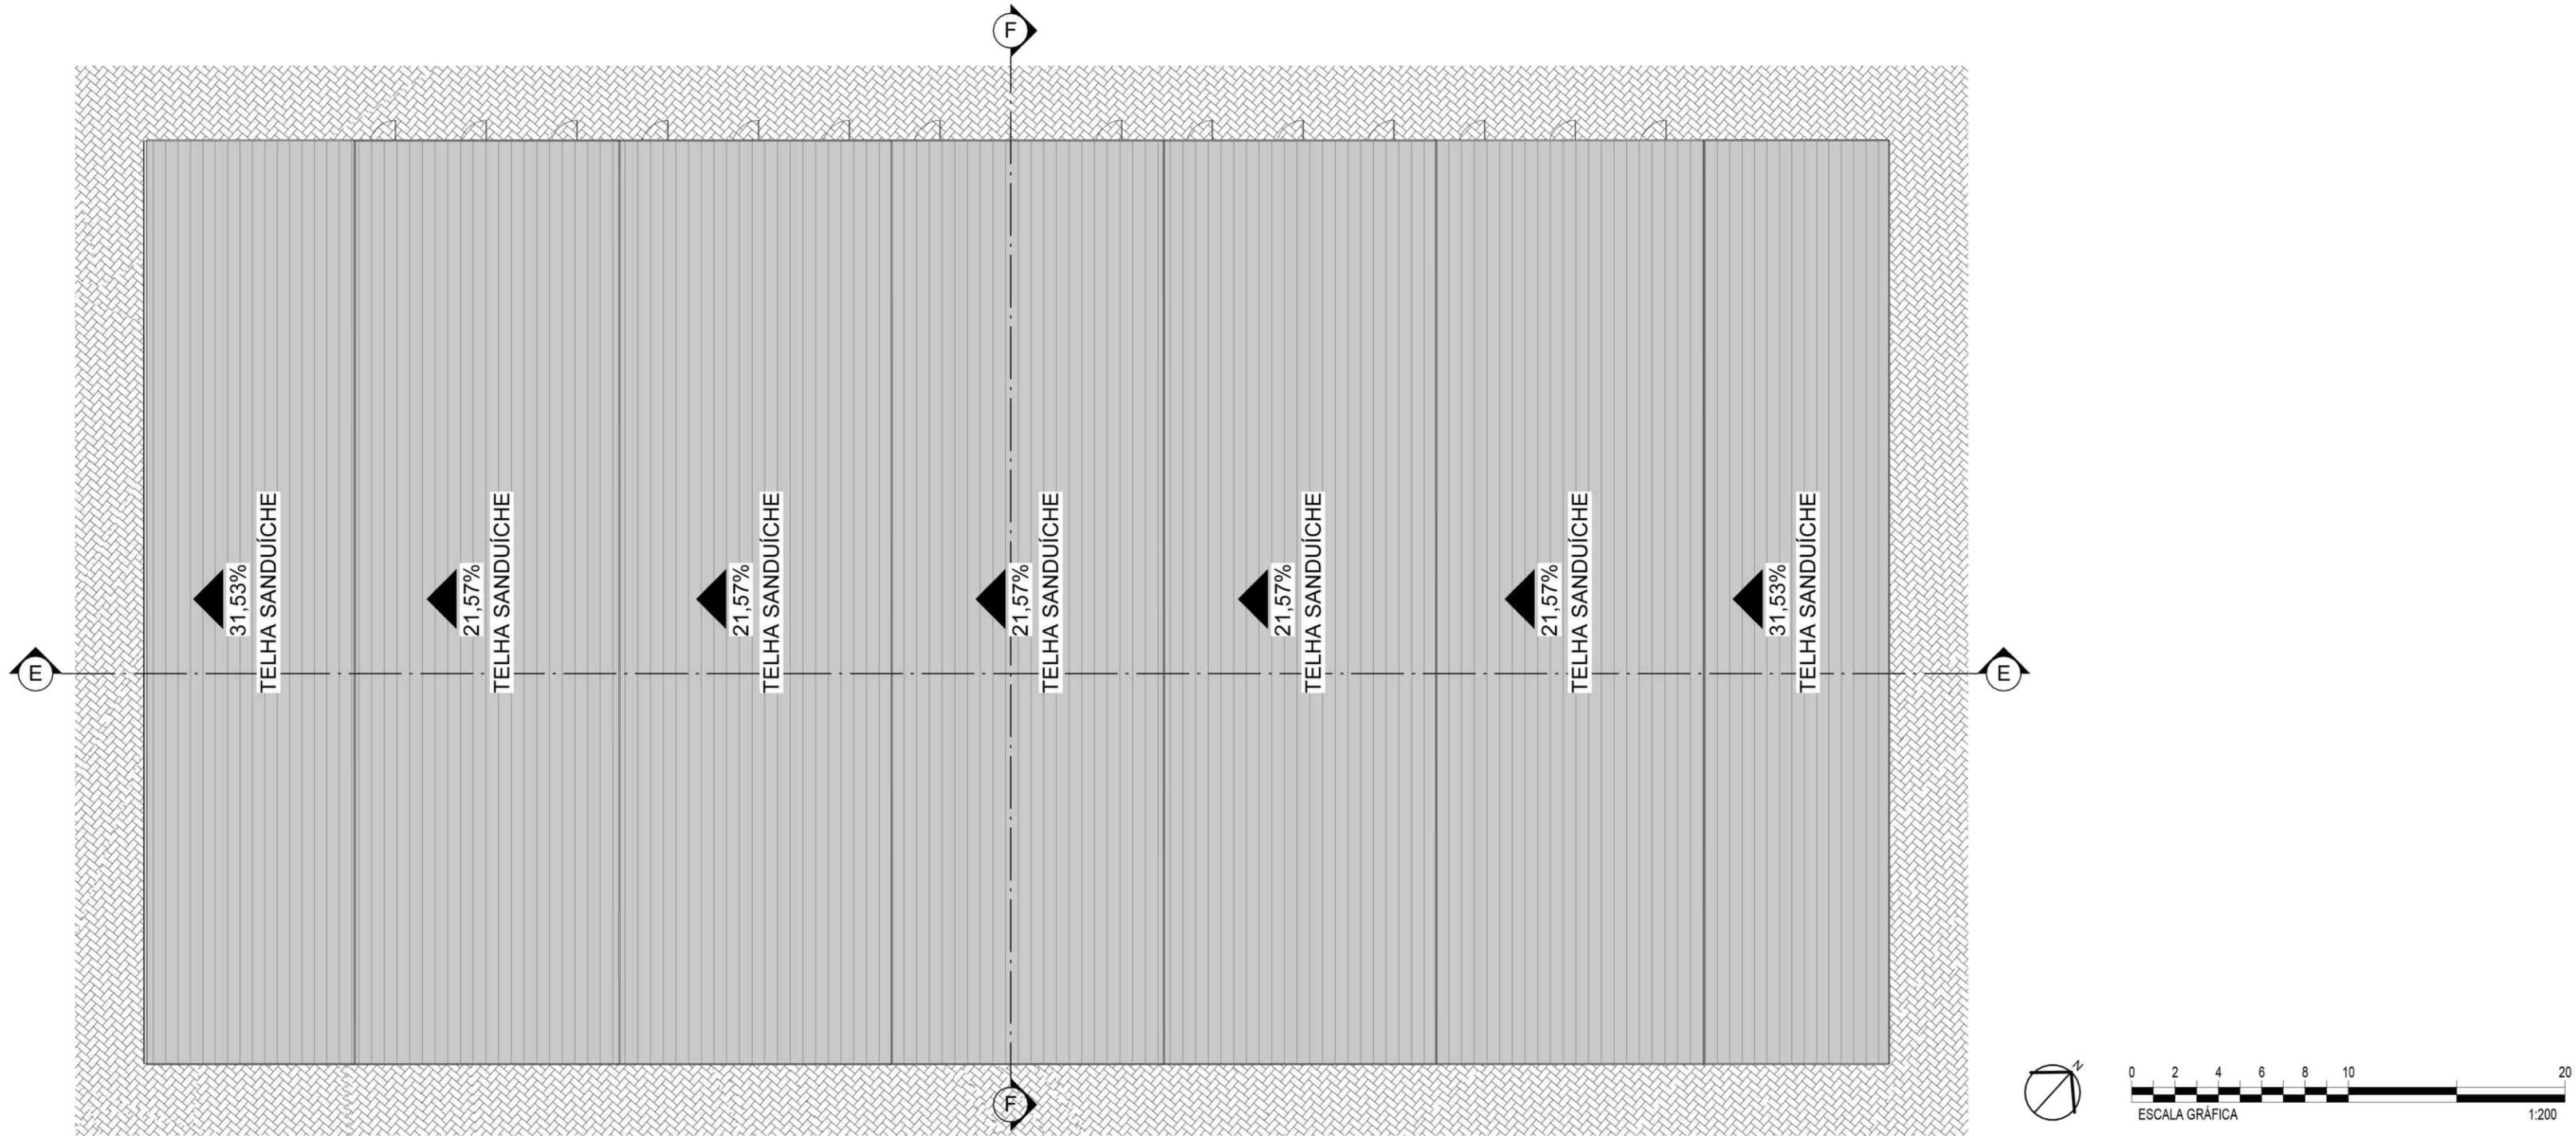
Planta de cobertura picadeiro coberto Fonte: Autora (2024)
